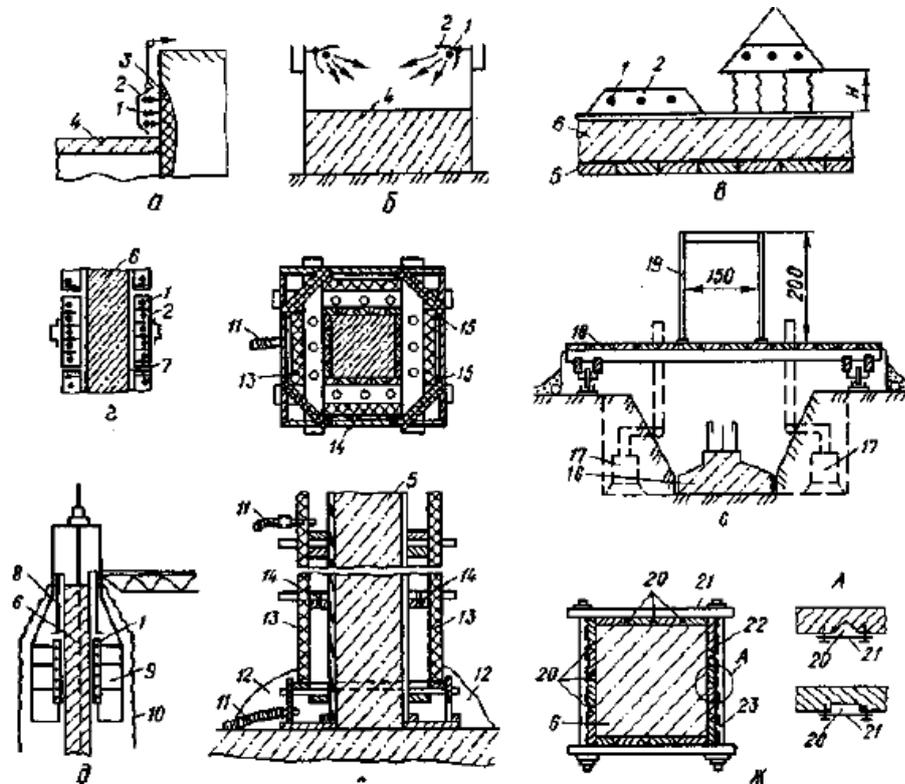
Схеми інфрачервоного обігрівання, прогрівання, тепляка, капілярної опалубки: а – схема інфрачервоного обігрівання мерзлого бетону і основи; б – те саме, у разі теплового захисту укладуваної бетонної суміші; в – те саме, для забезпечення інтенсивності твердіння бетону перекриття; г – те саме, бетону стін у металевій опалубці; д – те саме, у ковзній опалубці; е – схема паропрогрівання колони; є – схема тепляка під час улаштування фундаментів; ж – схема капілярної опалубки колони; 1 – інфрачервоний випромінювач; 2 – рефлектор; 3 – зона відігрітого бетону; 4 – новоукладений бетон; 5 – опалубка; 6 – бетон, що обігривається; 7 – металева опалубка стін; 8 – ковзна опалубка; 9 – риштування; 10 – брезентове покриття; 11 – гнучкий шланг для подавання пари; 12 – тирса; 13 – утеплені щити; 14 – отвори у хомутах; 15 – повсть; 16 – улаштовуваний фундамент; 17 – печі; 18 – пересувний тепляк; 19 – кабіна для вивантаження бетонної суміші; 20 – канали для пари; 21 – смужка покрівельної сталі; 22 – щит опалубки; 23 – хомут
